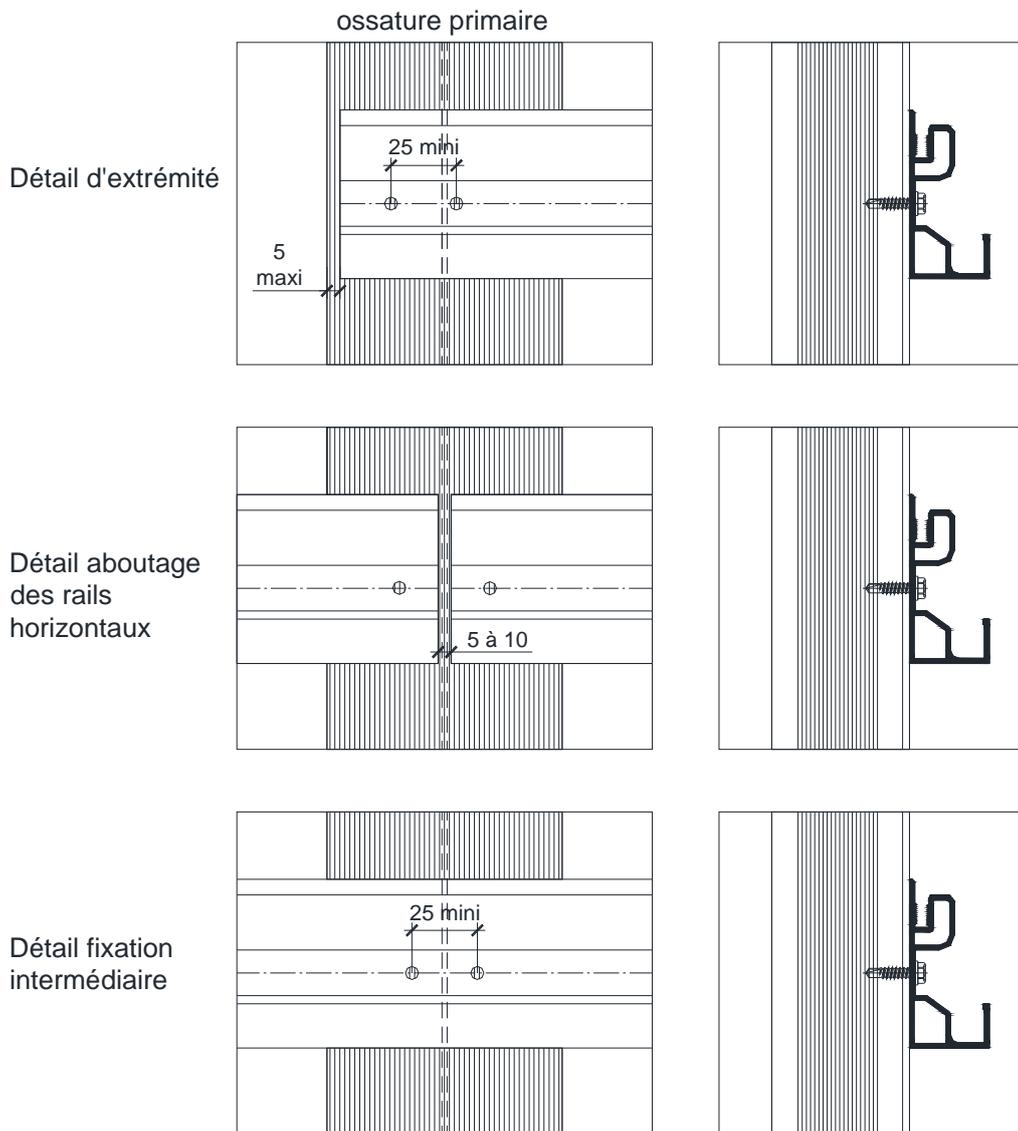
Détails fixations des rails horizontaux sur profilés en T
